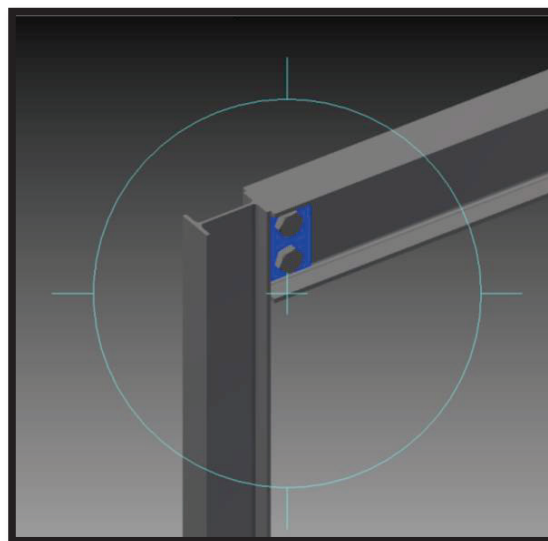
Posición de la placa para conexión viga de carga-columna posterior.
